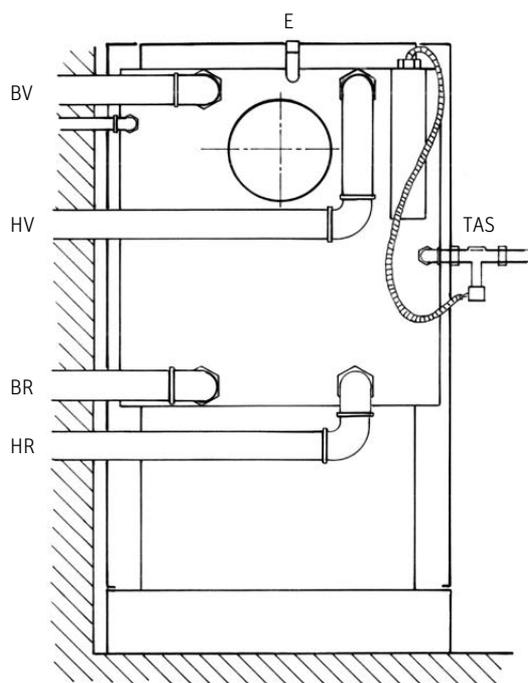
Collegamenti verso un lato e dispositivo di scarico di termoprotezione
